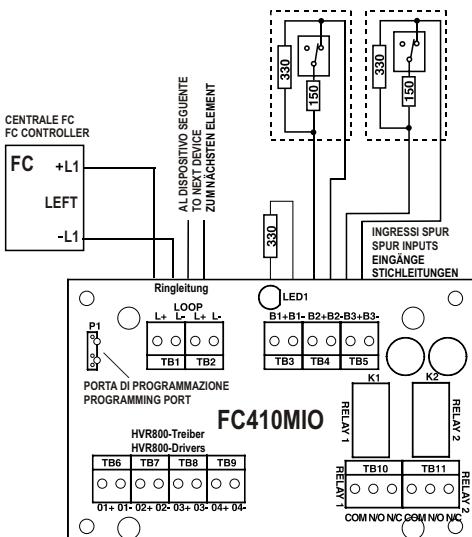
Sticheitungen Öffner-Kontakte; Störung bei Kurzschluss
